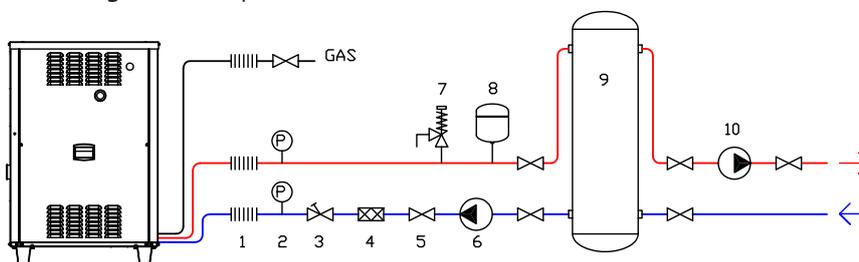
Plan Speicher 2 Anschlüsse
